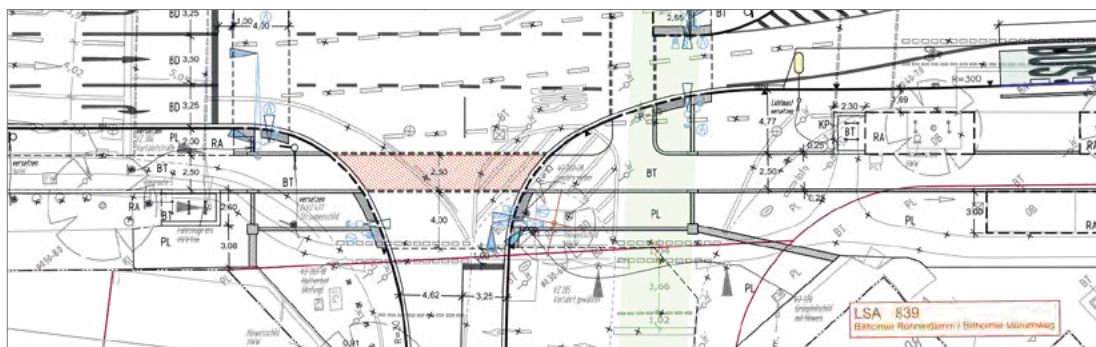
Ausschnitt Planung Busoptimierung Billhorner Röhrendamm / Billhorner Mühlenweg. © LSBG / Ingenieurbüro Münster
